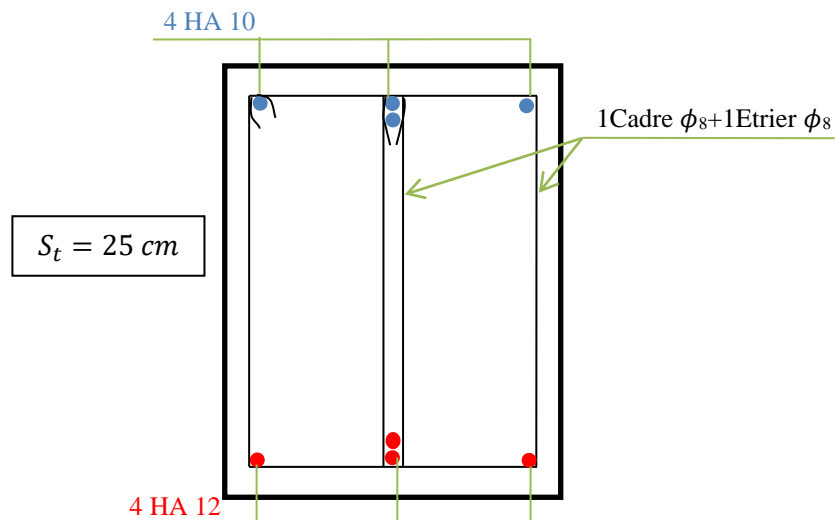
Schéma de ferrailage de la poutre de chaînage
